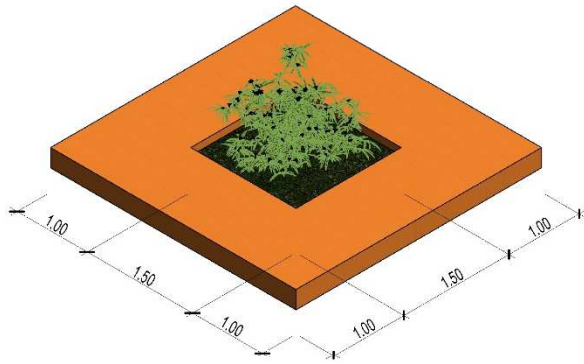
Planta y elevación de diseño de bancas de la plaza central.
